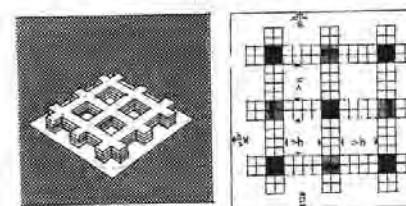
Foto und Schemagrundriss einer zweiseitigen Bebauung im 40-m-Großmodul mit zweiteiligen Baukörpern (Zellen).
